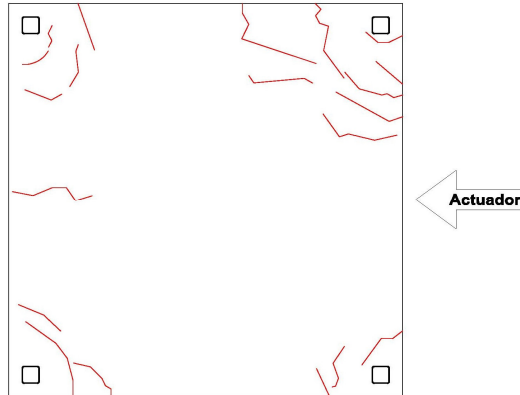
Micro-fisuración observada en la parte inferior de la losa de HA.
